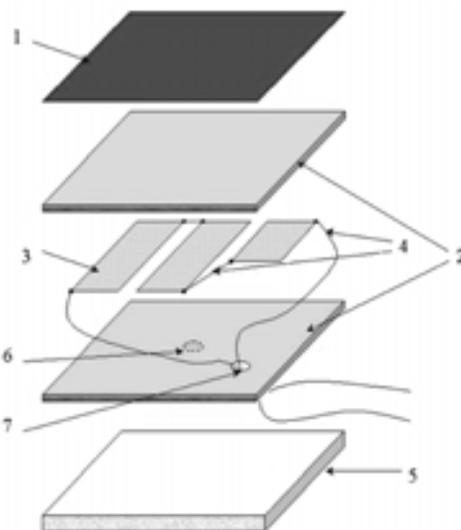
Конструкция греющей опалубки: 1 – защитное, износостойкое, влагостойкое покрытие; 2 – влагостойкая фанера 9 мм; 3 – ленточный нагреватель; 4 – соединительные провода; 5 – теплоизолятор; 6 – выборка под установку термодатчика; 7 – выводное отверстие
